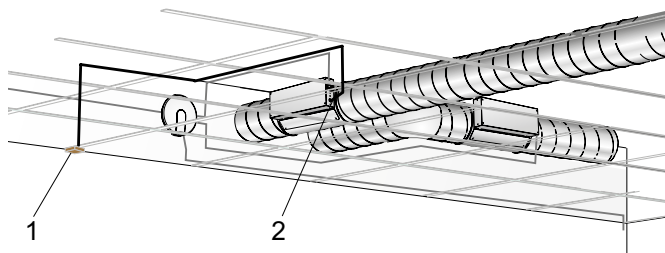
Installation du câble d'extension pour TUNE Adapt.
